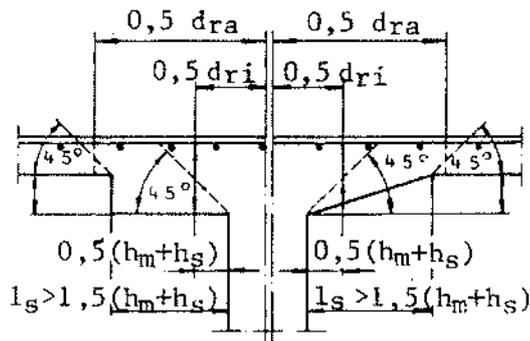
Losa apoyada sobre columnas con refuerzo, según párrafo c) con $l_s > 1,5(h_m+h_s)$
